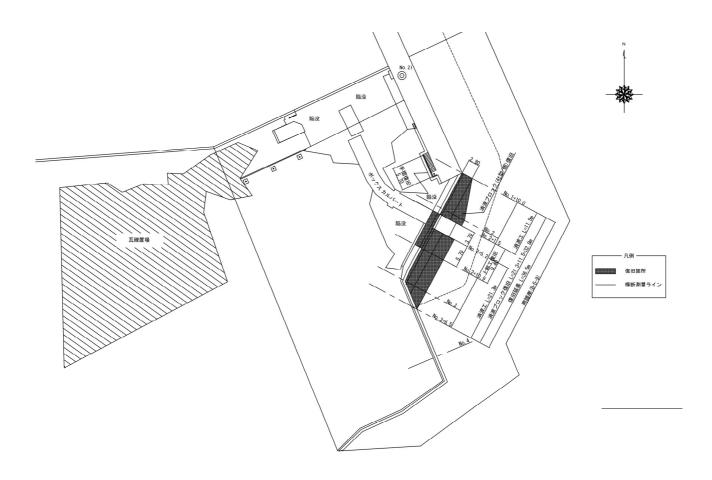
No.9 玉の脇地区_南護岸の平面図(復旧後)
